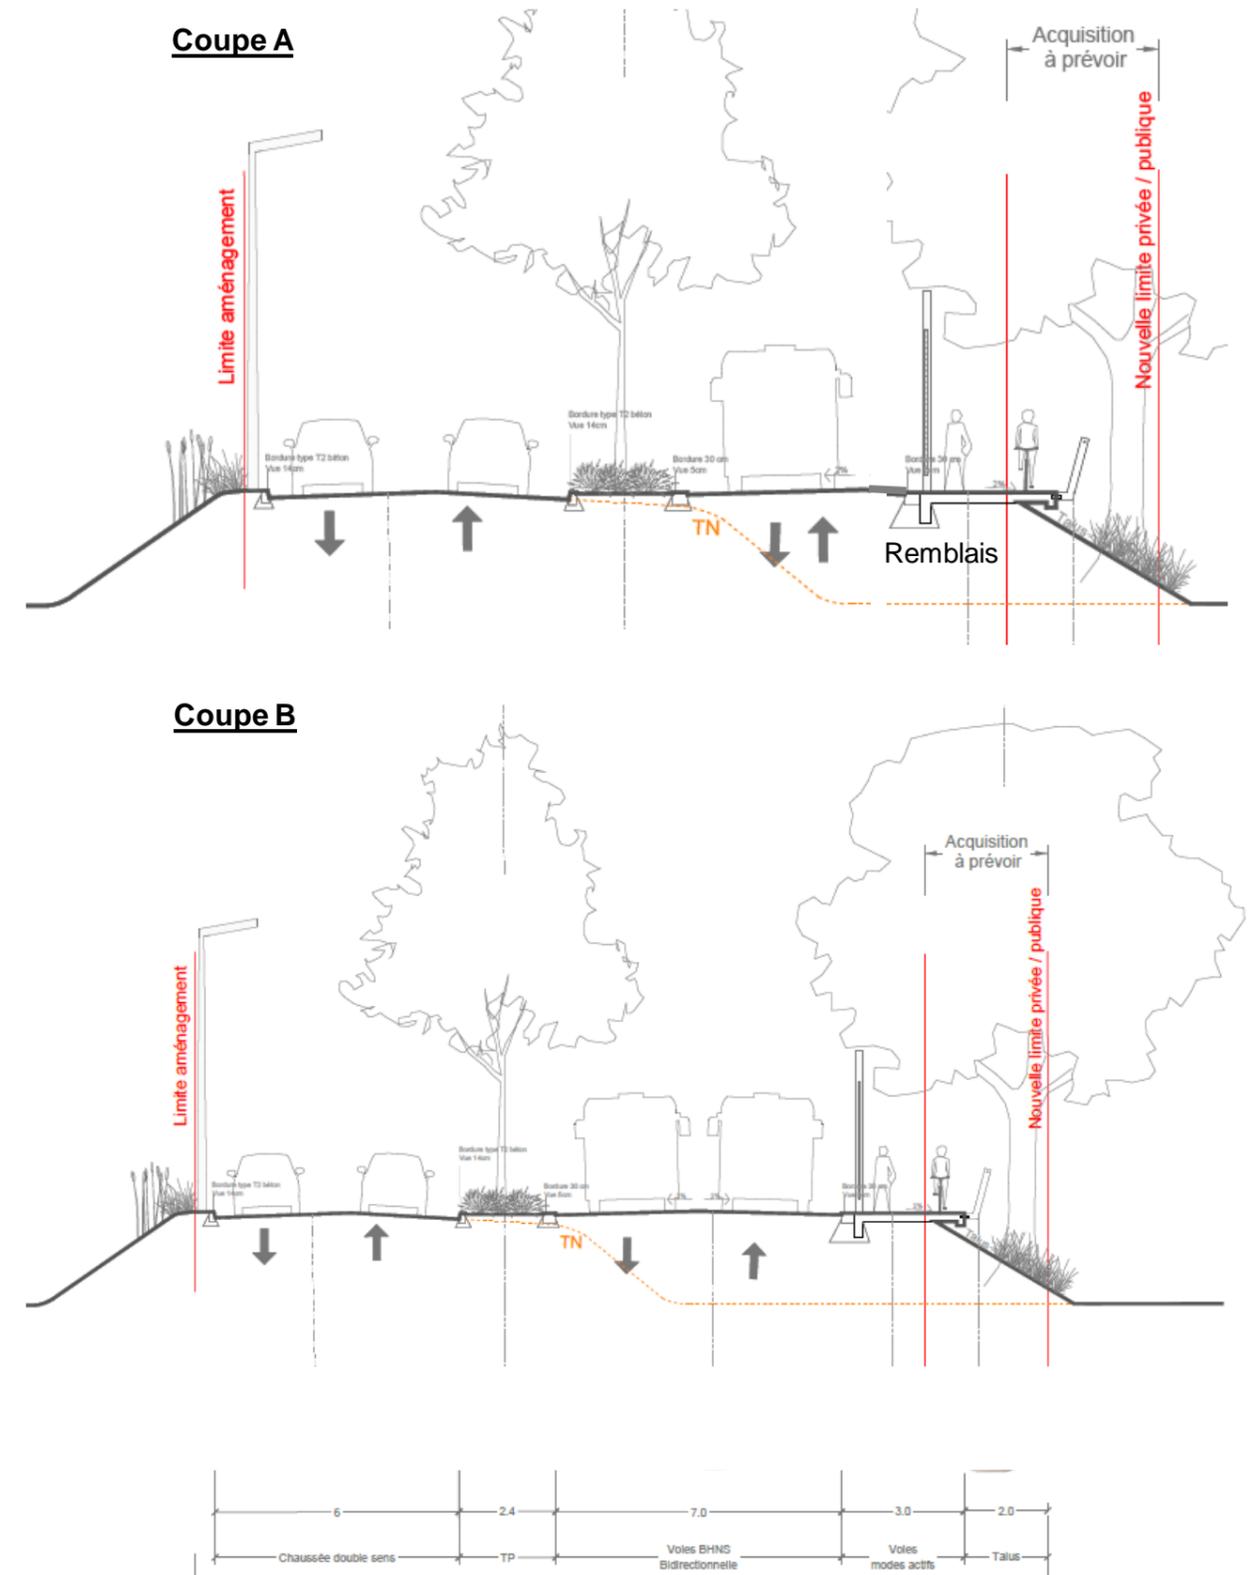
Coupe de l'élargissement de la route de Saint Gilles au niveau de la plaine agricole
